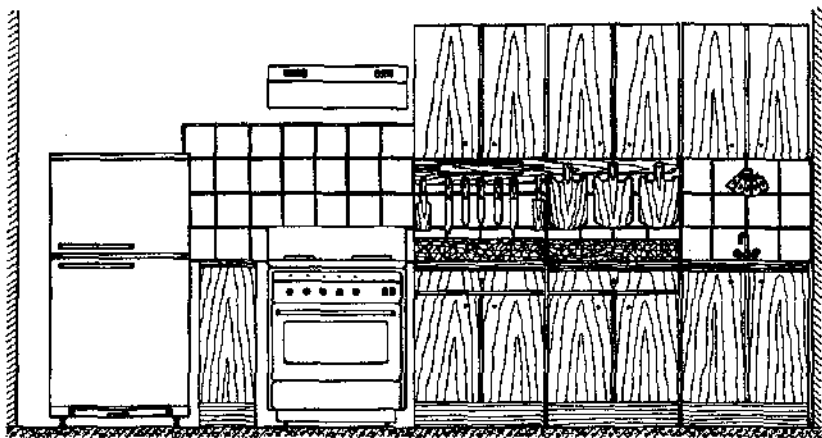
Вариант размещения кухонного оборудования вдоль одной стены
